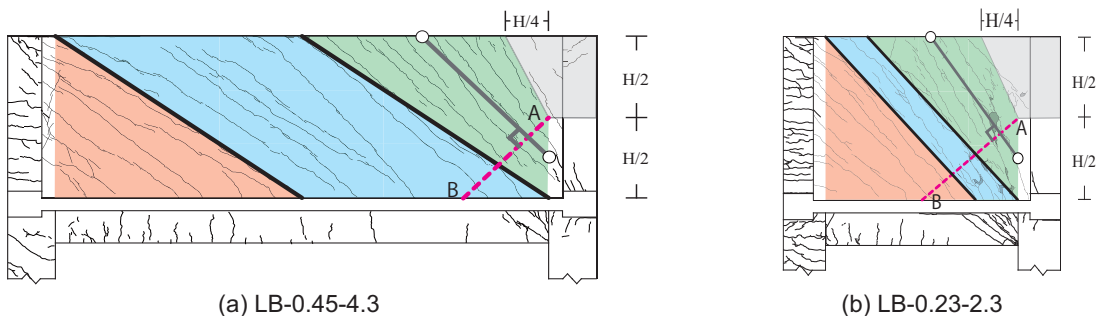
最大耐力時試験体ひび割れ図 (正載荷)
